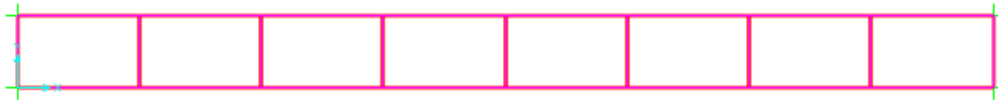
Modelo tipo *Shell* de Viga 3 en SAP2000 (vista en planta). Fuente: Autor.
